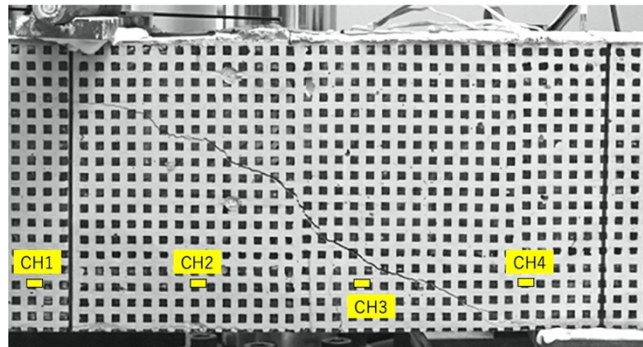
供試体 FF2 の破壊時ひび割れ状況と鉄筋ひずみゲージの配置
